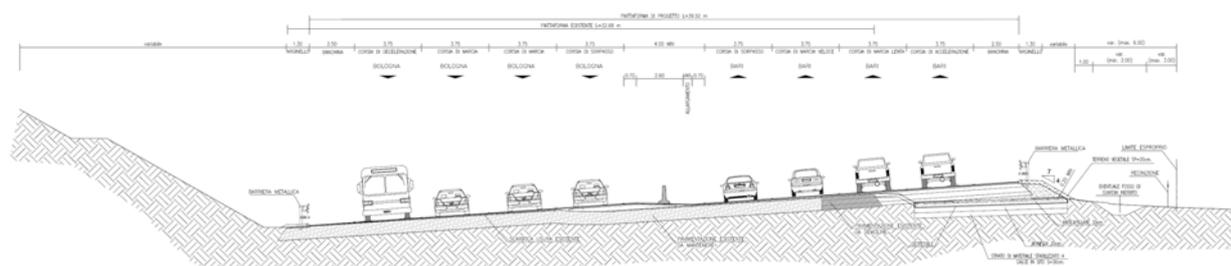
Sezione tipo in trincea in corrispondenza dei rami di svincolo – tratto finale
